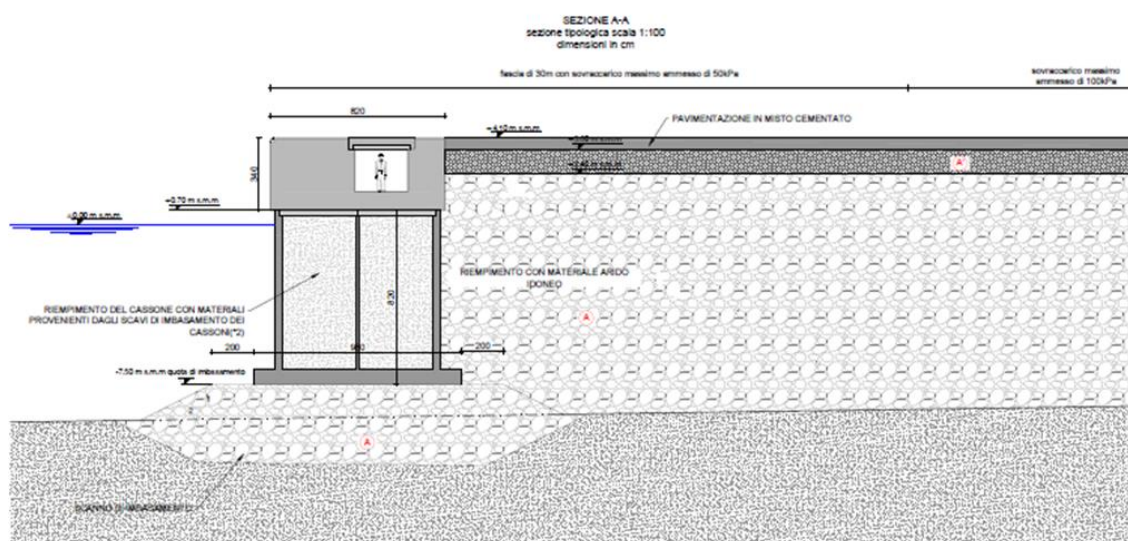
sezione tipologica di posizionamento della struttura tecnica sui cassoni successivamente alla demolizione del muro a mensola realizzato in Fase 1.
